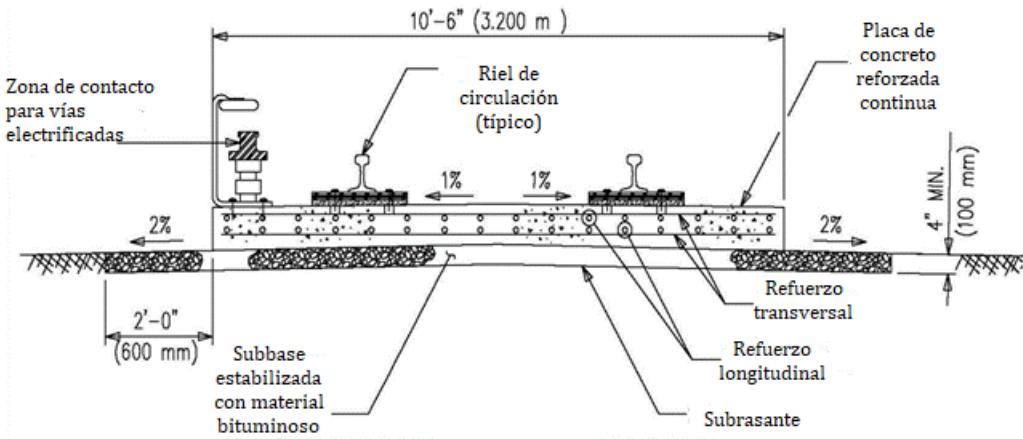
Sistema de vía en placa continua de concreto reforzado (*slab track*).
